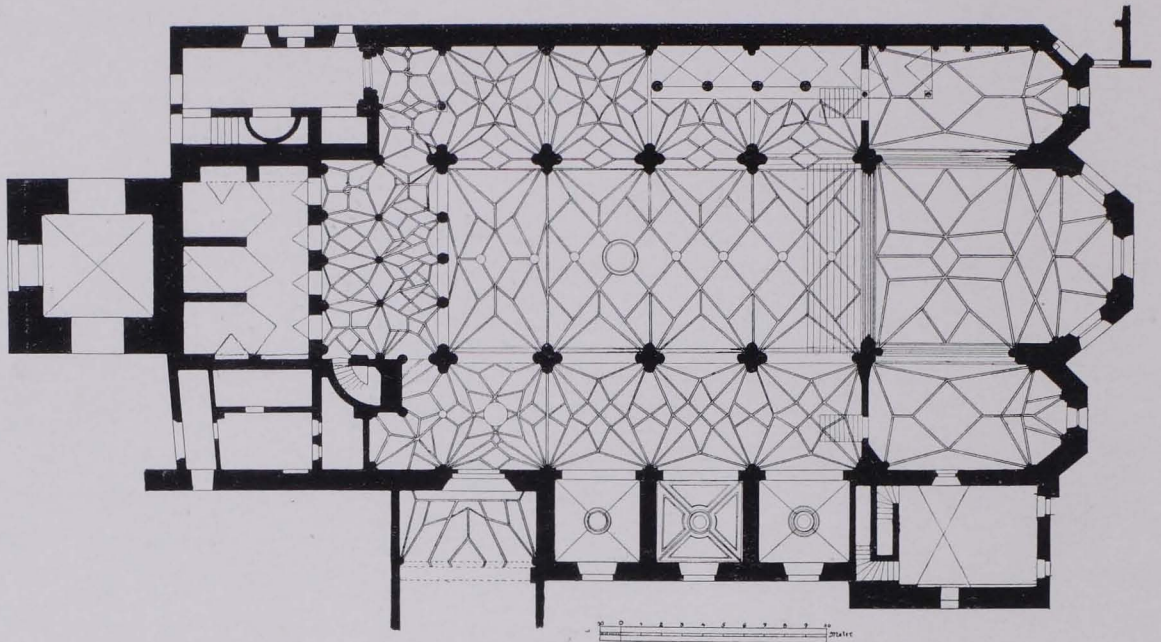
Stiftskirche, Grundriß 1:350 (S. 3)
